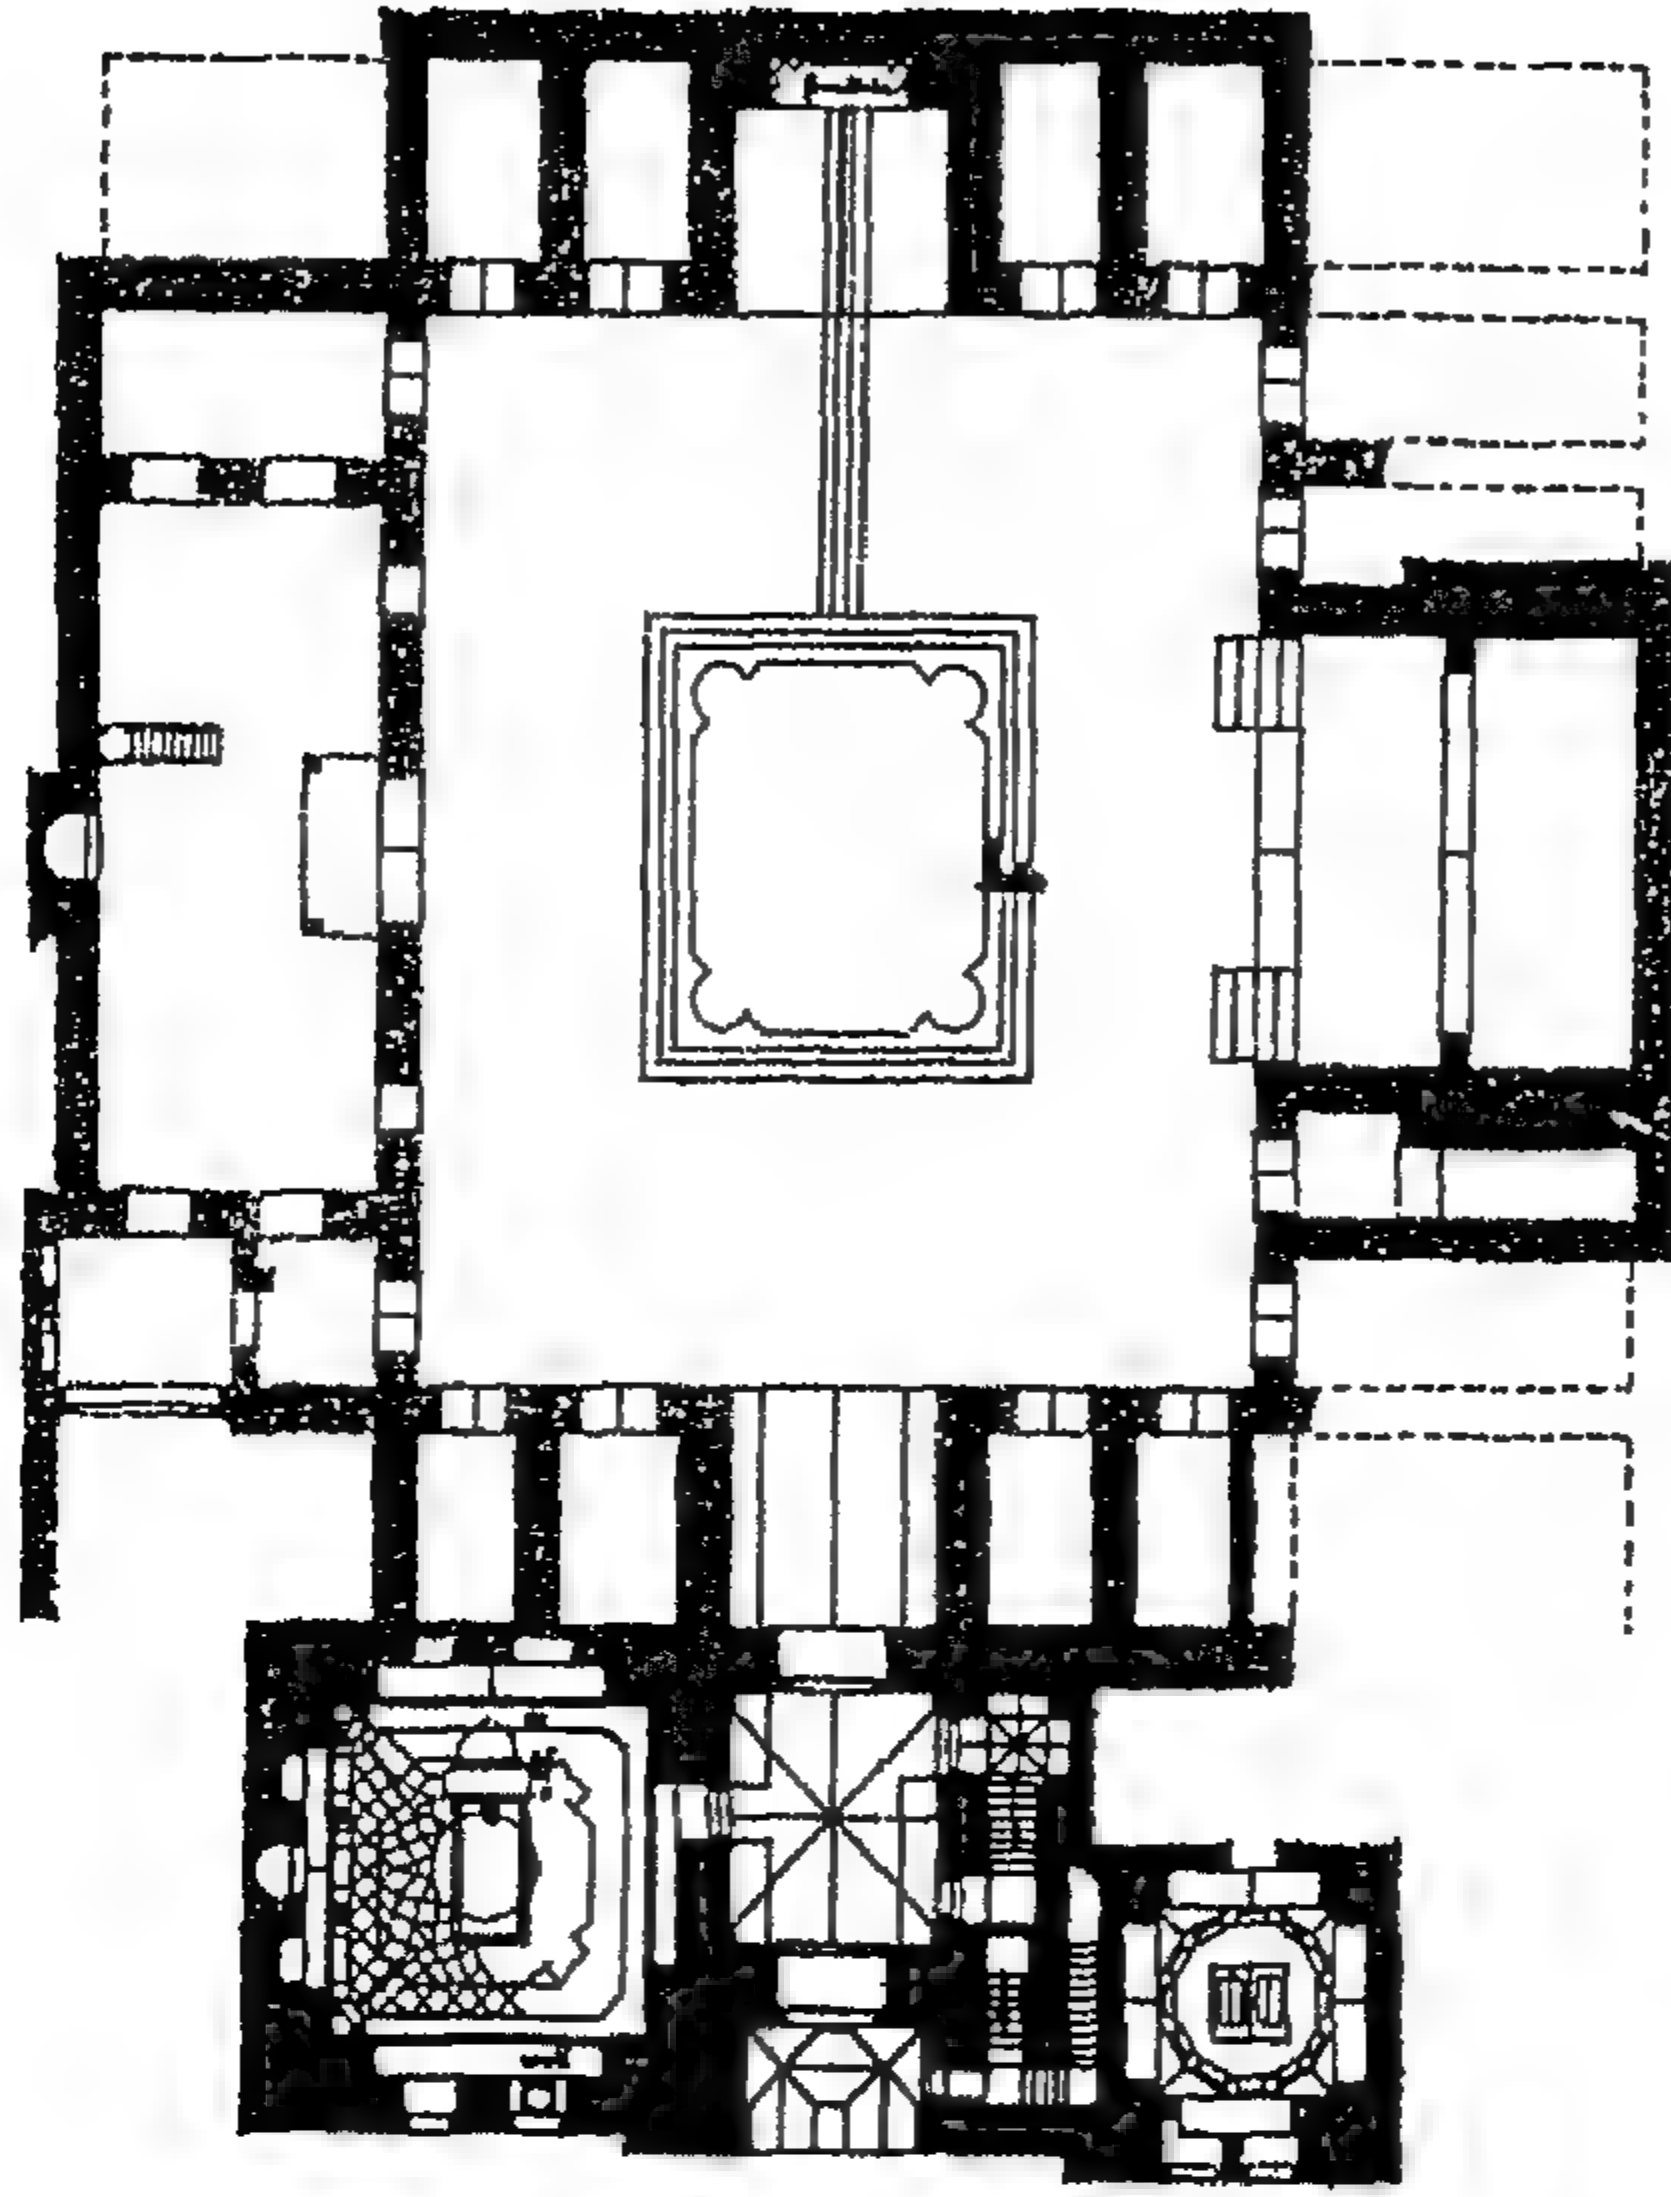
مسقط أفقي لجامع السنانية بدمشق
